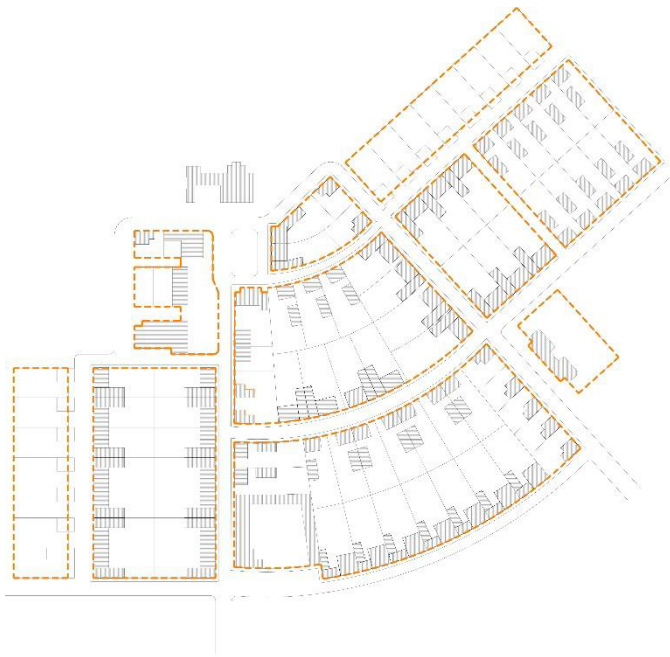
Planta manzanas de Sodeto. Fuente: Elaboración propia
